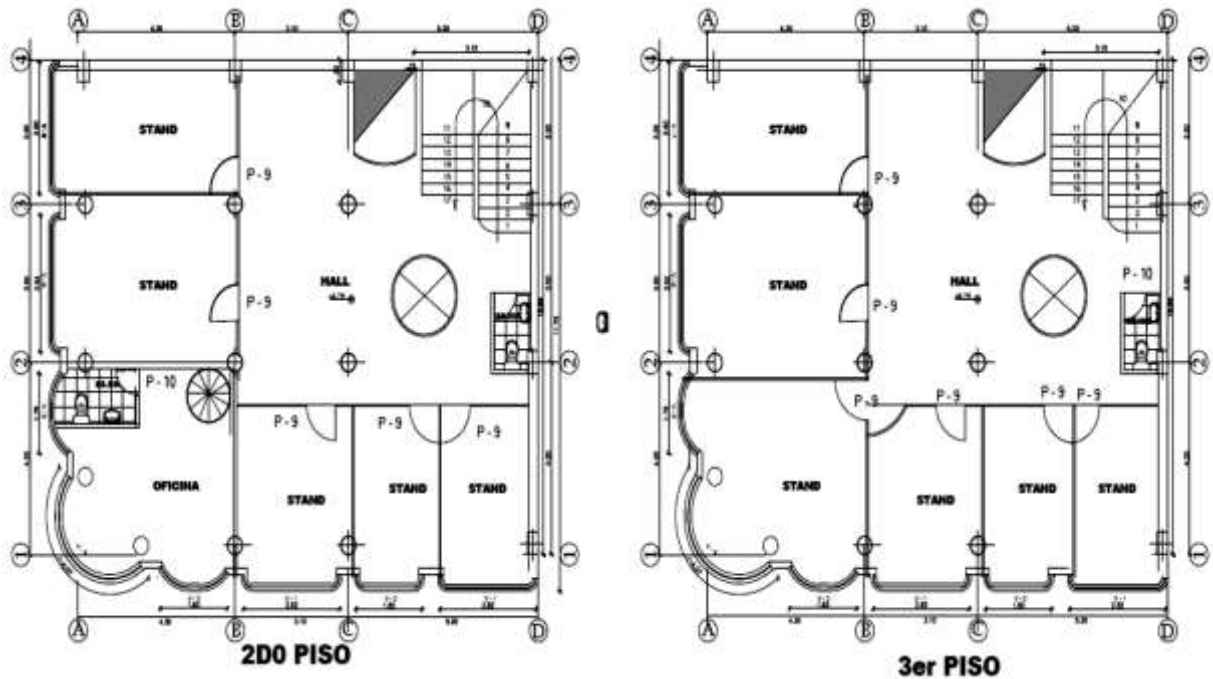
Plano en planta 2do y 3er nivel del edificio comercial-hotel.
